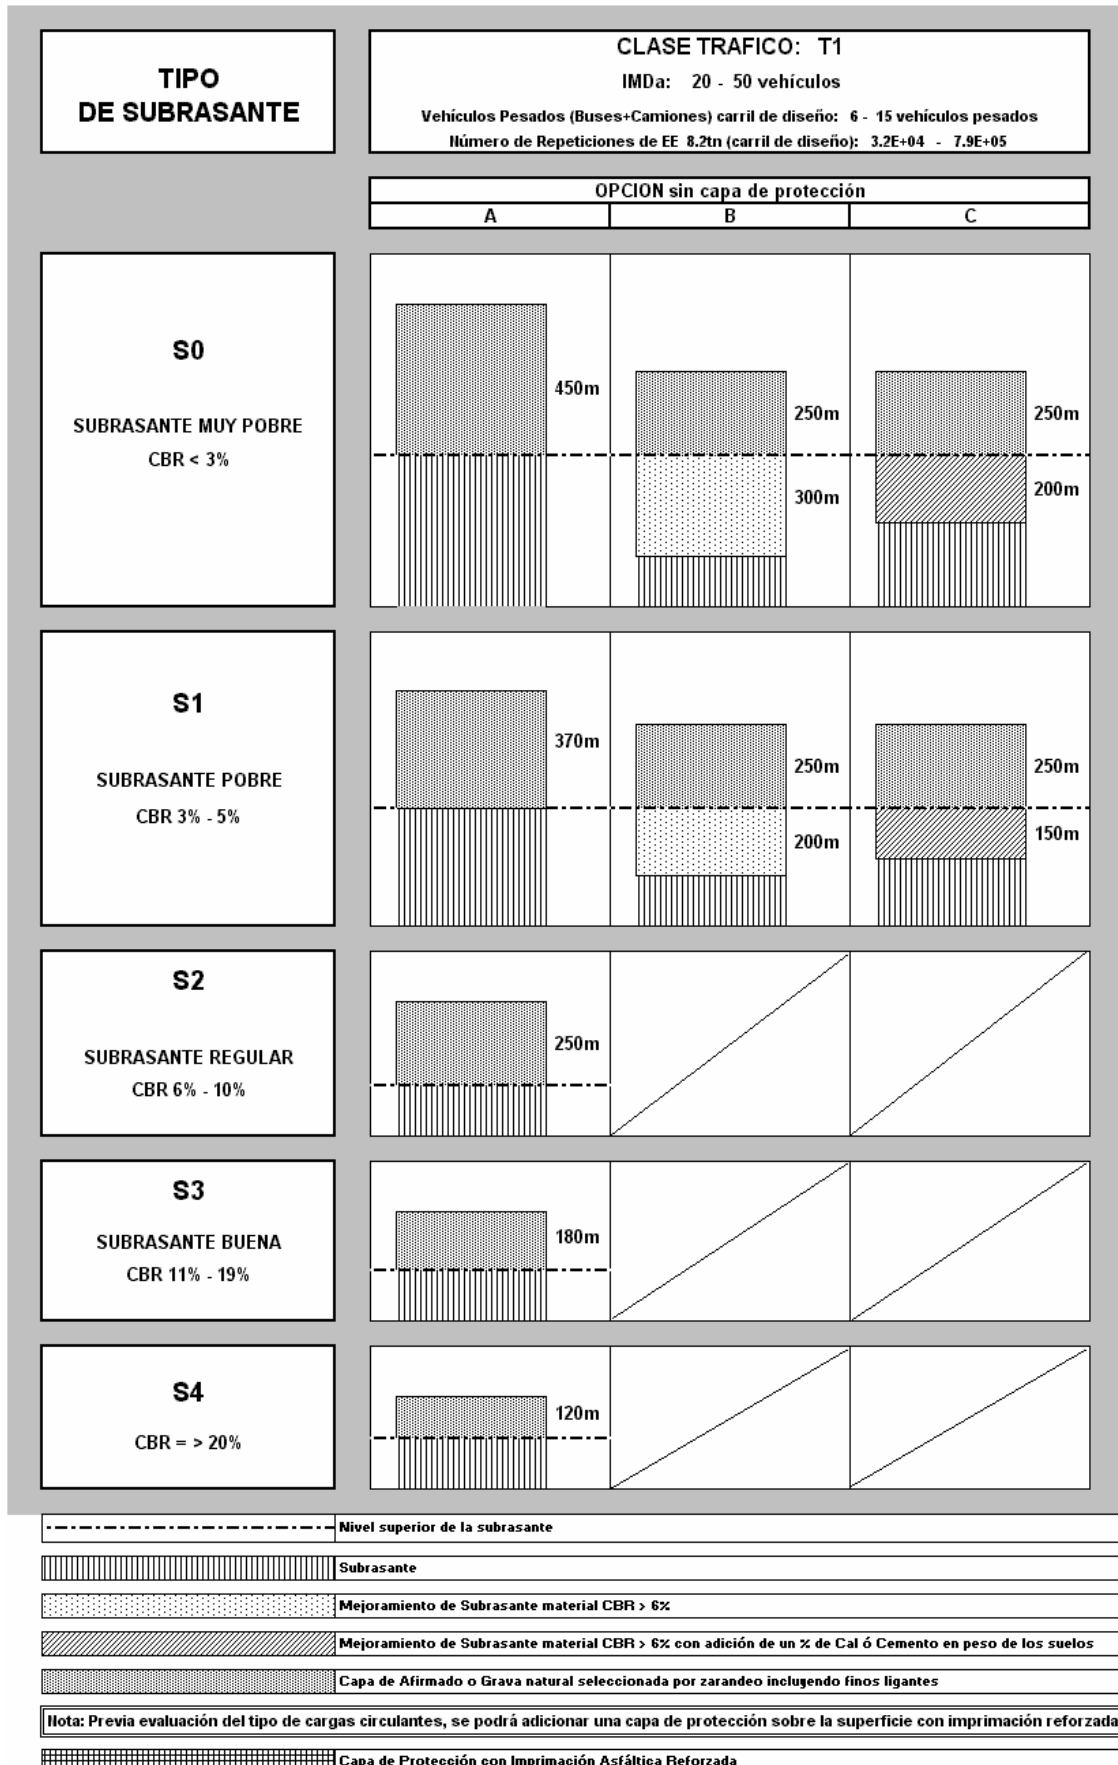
Estructuras de Pavimentos (Fuente: Wikipedia)
